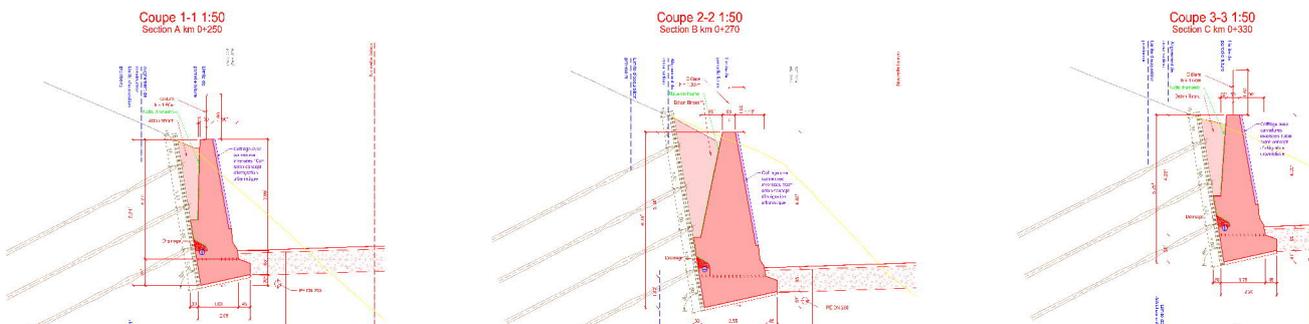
Coupes transversales du Mur des Fontanettes amont
